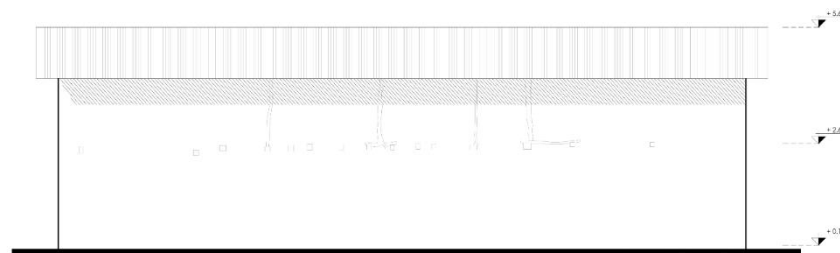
Detalles constructivos del inmueble y disposición de bloques de adobe. Fuente: Archivo propio.
